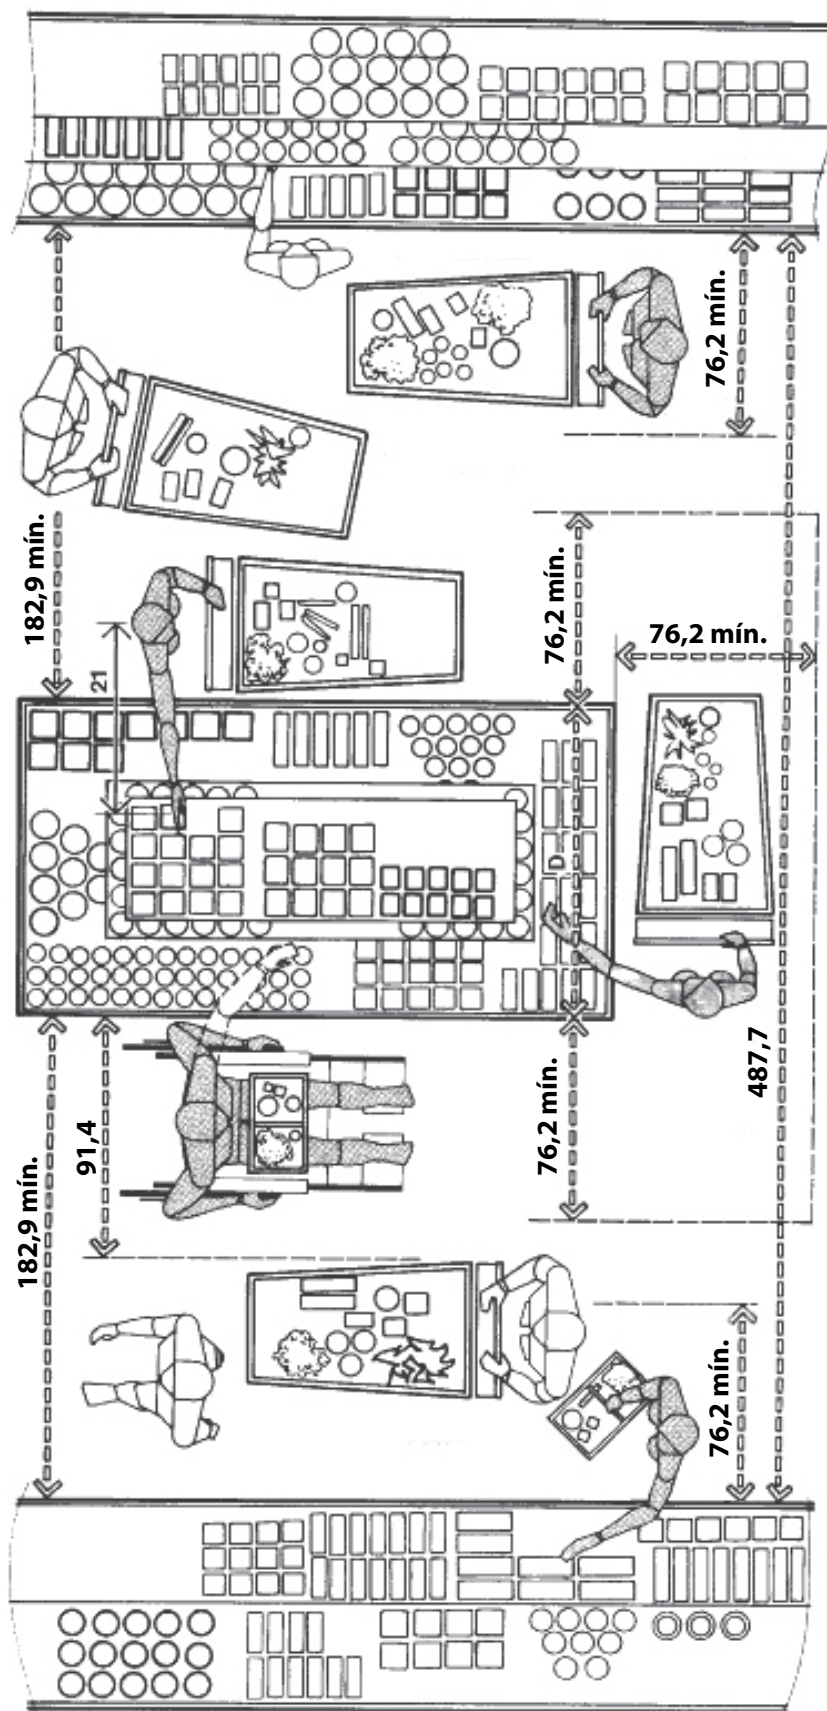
Dimensões do das larguras do local de varejo em centímetros (cm)
